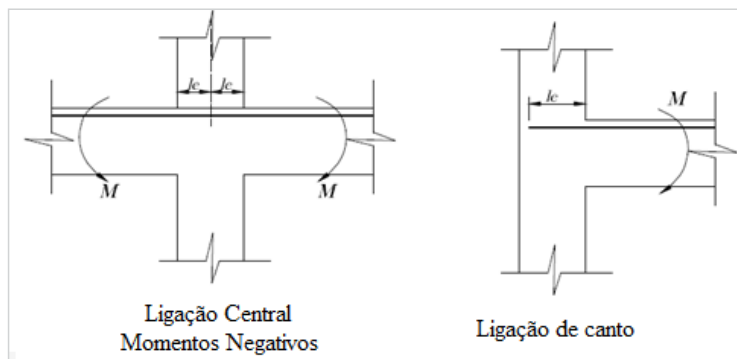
Comprimento de embutimento para ligações viga-pilar monolíticas
